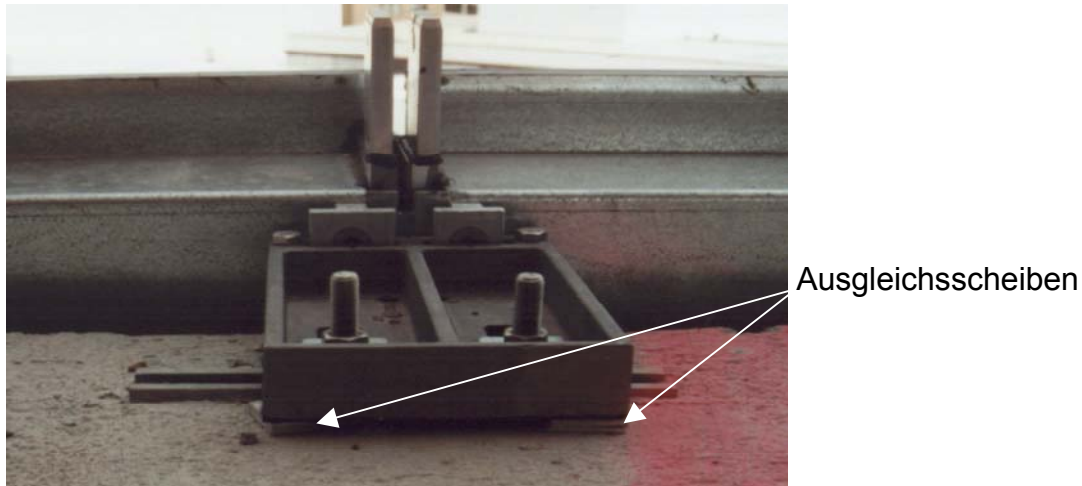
Fertig montierte Fassadenbefestigung mit zu hoch eingebauter Schiene
